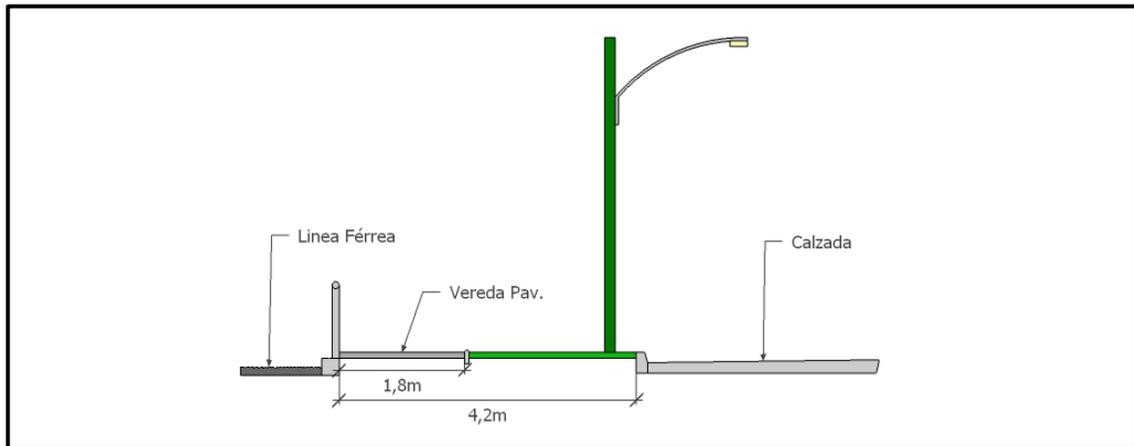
Perfil Transversal Eje A (Av. España) / Sector A2 / 2
